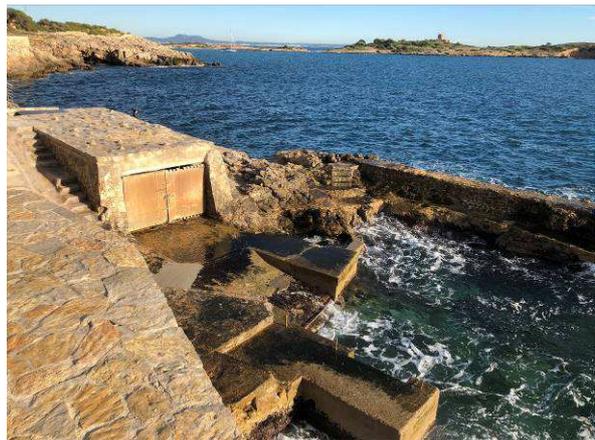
Vista de caseta guardabotes, rampa, escalinatas de Acceso y mollets frontales
